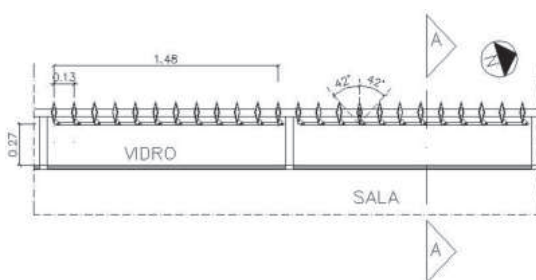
Planta baixa representativa da distribuição dos brises verticais.⁹
